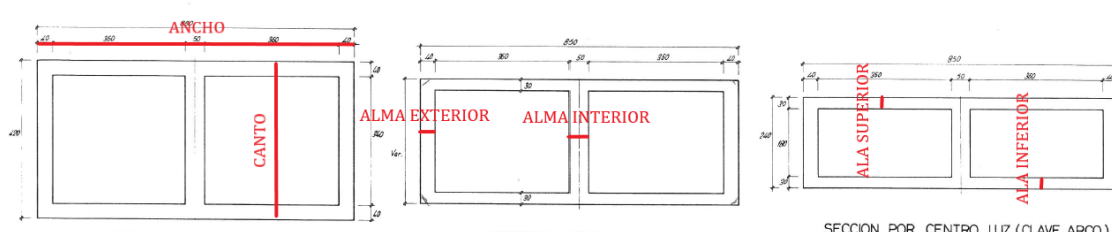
PARÁMETROS DE LAS SECCIONES DEL ARCO.
